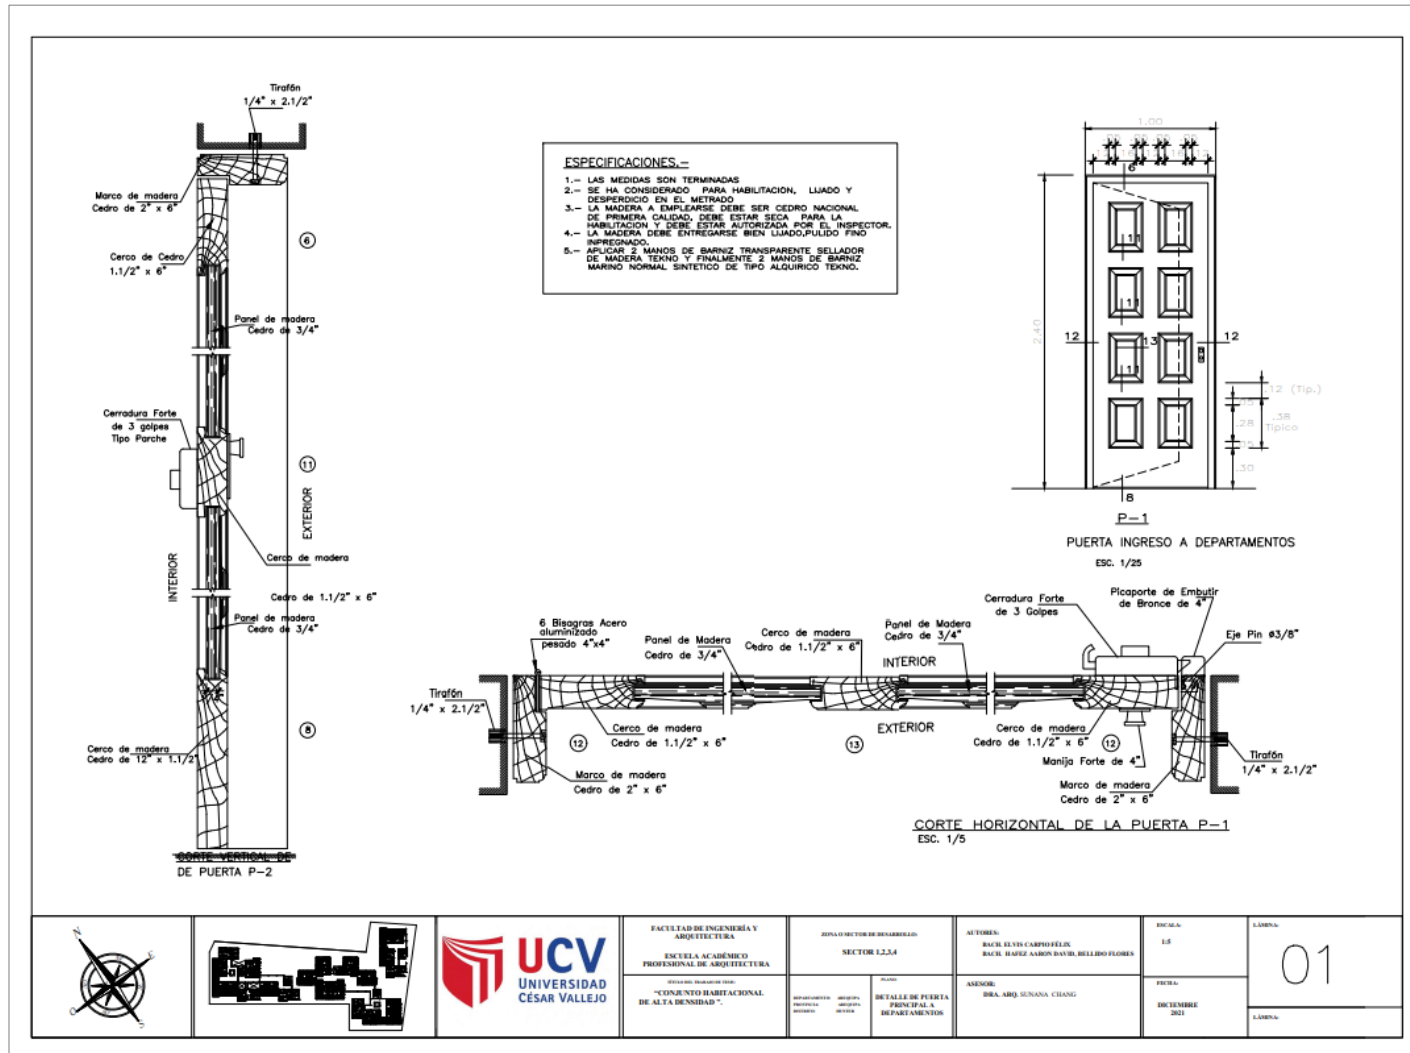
Plano de Detalle Arquitectónico - Puertas 01
